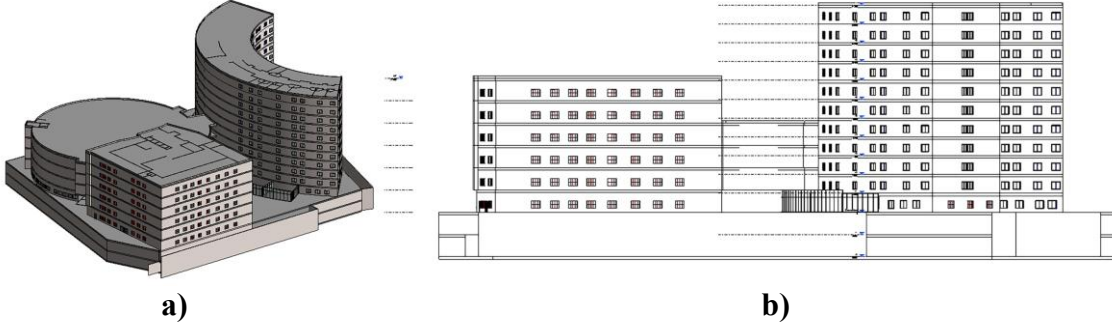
Vaka₂ kapsamında örneklenen, Revit platformu kullanılarak uygulama çizimleri oluşturulan ofis yapısına ait vaziyet planı (MTO₂ 2019)
